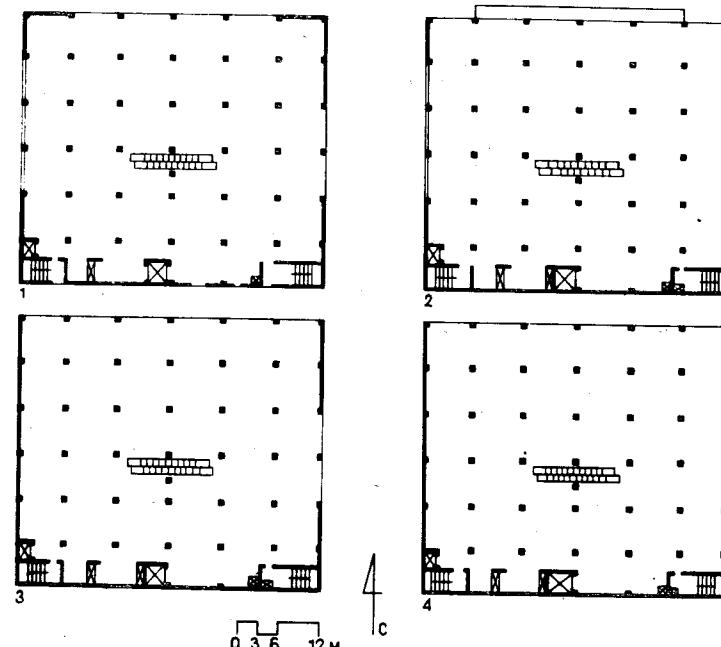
Планы здания универсального магазина Дж. С. Пенни
